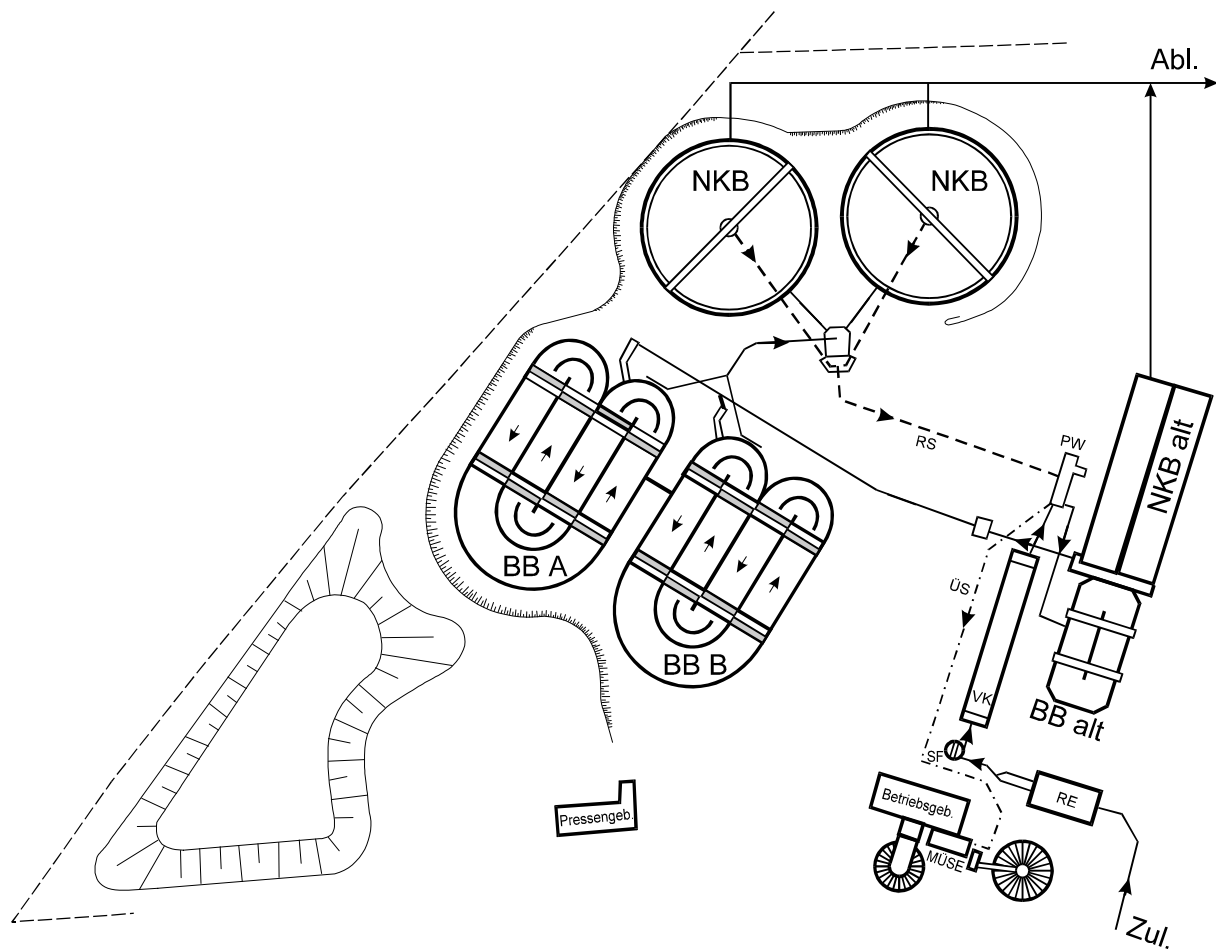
Lageplan der Kläranlage Bad Vöslau
